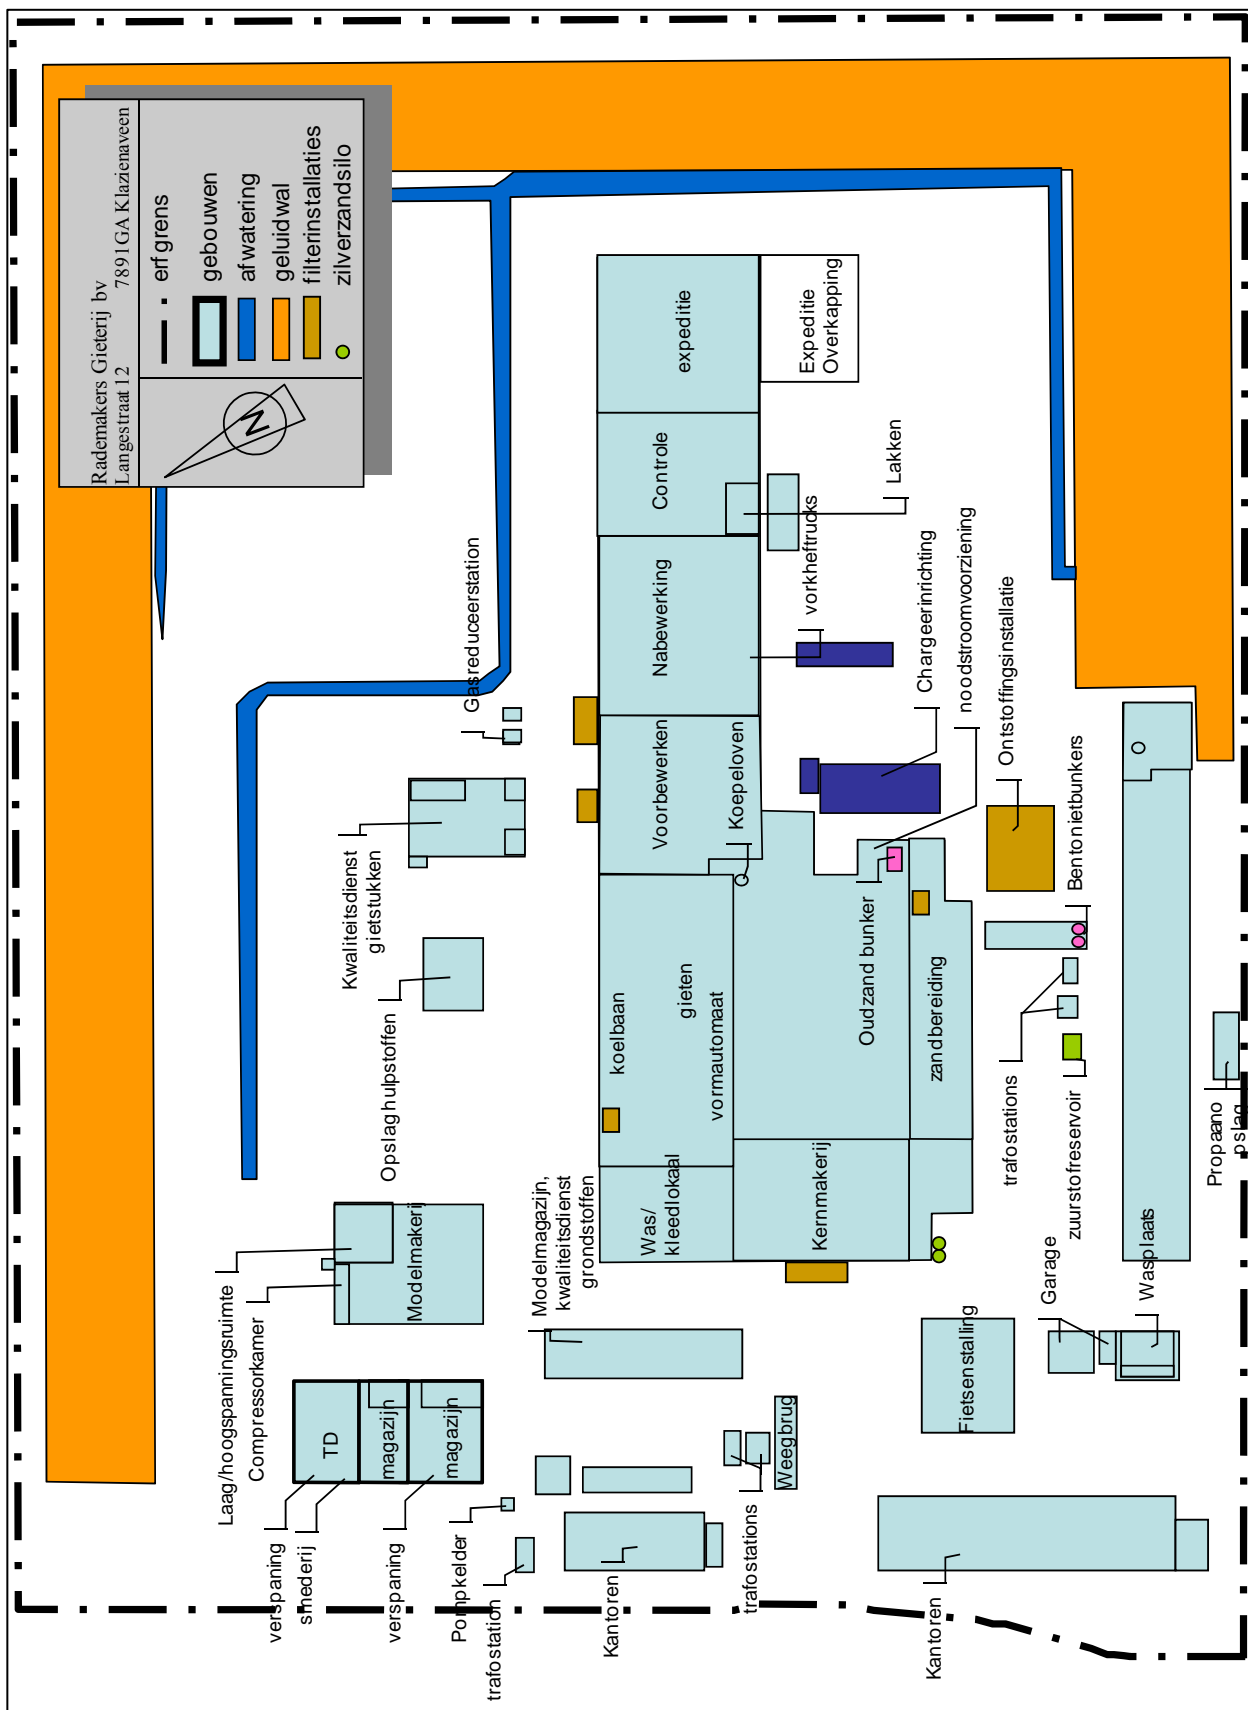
Situering van de inrichting t.o.v. de omgeving. Niet alle op het terrein aanwezige gebouwen zijn door het kadaster ingetekend..
